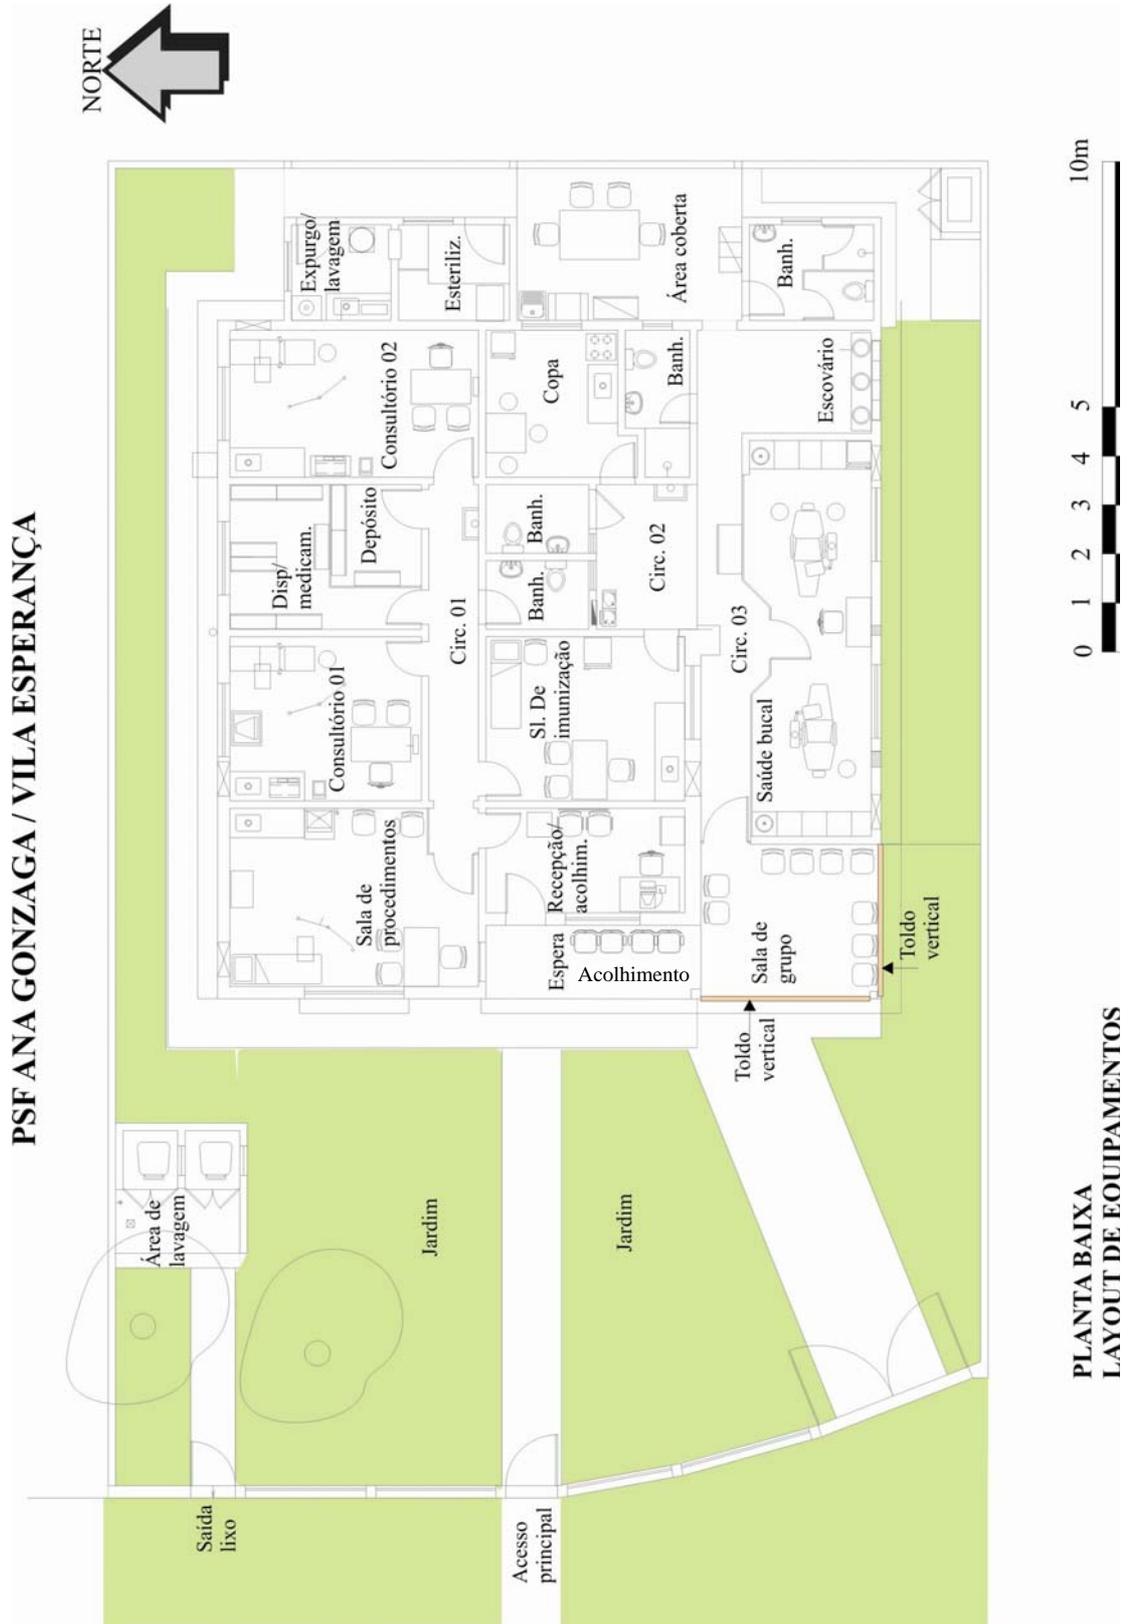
Planta Baixa de Arquitetura e de Layout de Equipamentos (Fonte: CIESZO).
